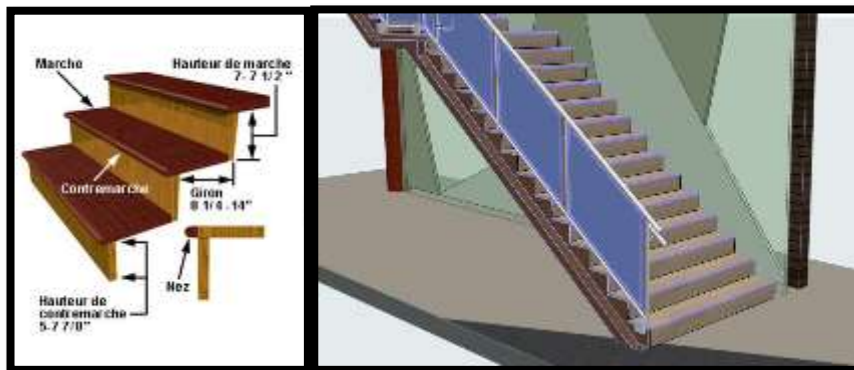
Détail escalier en béton pour le grand hall avec revêtement en bois
